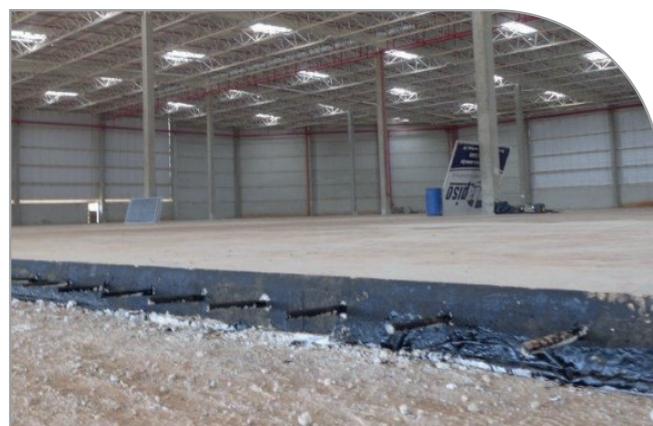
Camadas do piso de concreto para fins industriais. Fonte: google imagens.
